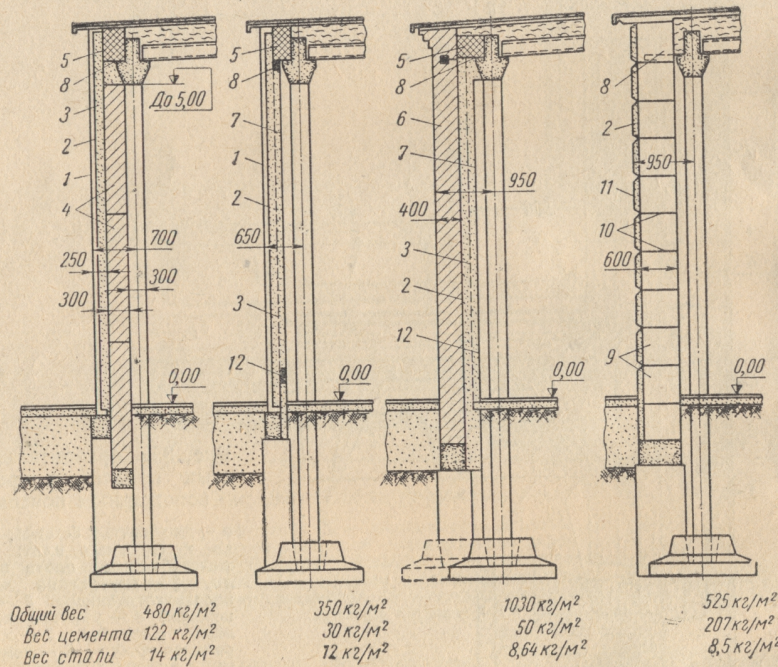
Конструкция наружных стен одноэтажных холодильников:
